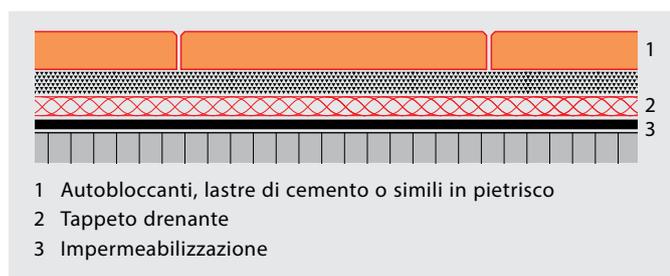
Struttura del sistema di uno strato di usura chiuso su struttura per tetto piano con isolamento termico.
